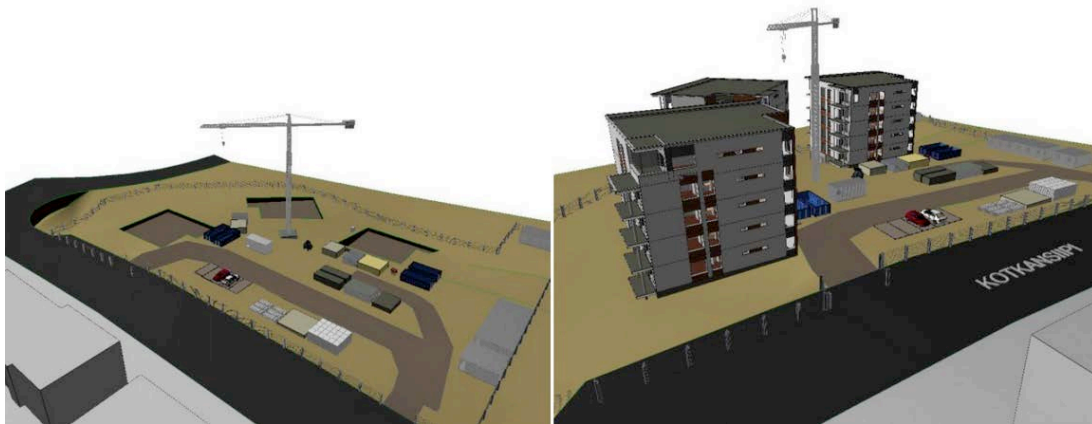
Un ejemplo de plano de emplazamiento 3D para la excavación y fase de estructura. (Fuente: VTT).
